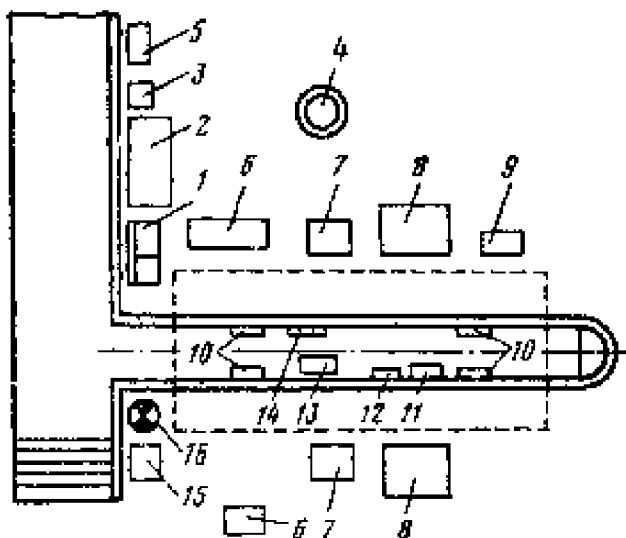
Схема технологической планировки тупикового поста ТО-2: 1 – ларь для обтирочных материалов; 2 – слесарный верстак; 3 – бак для тормозной жидкости; 4 – стеллаж-вертушка для крепежных деталей; 5 – тележка для транспортировки аккумуляторных батарей; 6 – пост электрика-карбюраторщика; 7 – пост слесаря-авторемонтника; 8 – тележка для снятия и установки колес; 9 – электрогайковерт для гаек колес грузовых автомобилей; 10 – подъемник канавный; 11 – установка для отсоса отработавших газов; 12 – электрогайковерт для гаек стремянок рессор (канавный); 13 – подставка при работе в осмотровой канаве; 14 – ящик для инструмента и крепежных деталей; 15 – маслораздаточный бак; 16 – воздухораздаточная колонка
